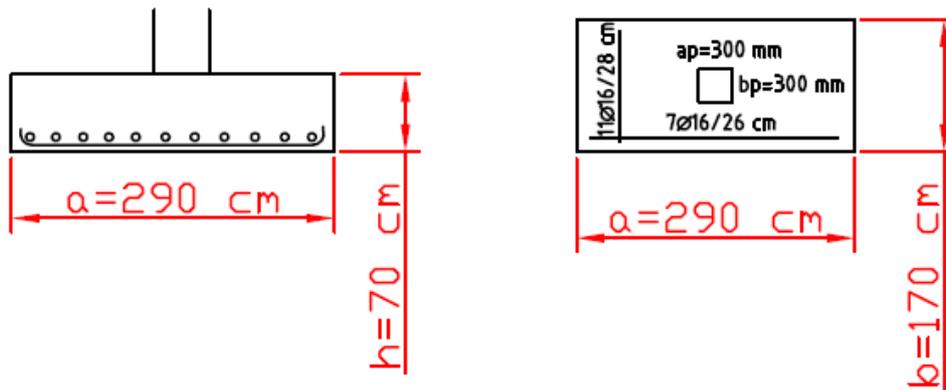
Croquis final de las zapatas de los pilares interiores.
